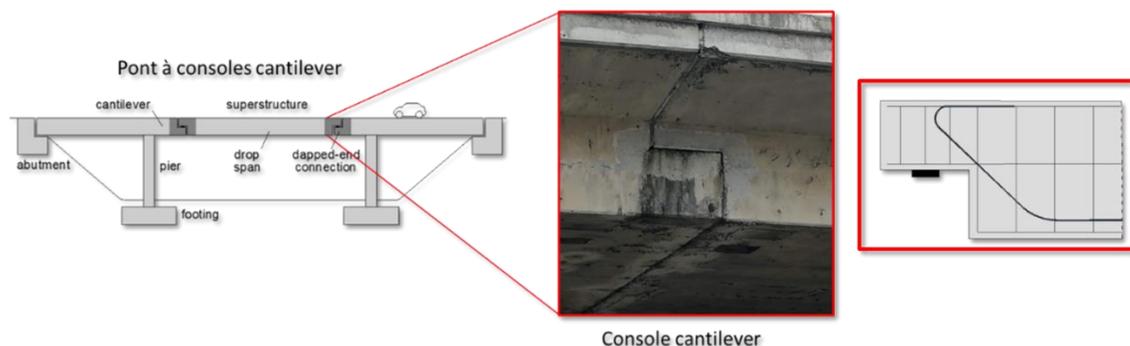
Exemple d'un pont à consoles cantilever situé à Liège, Belgique
